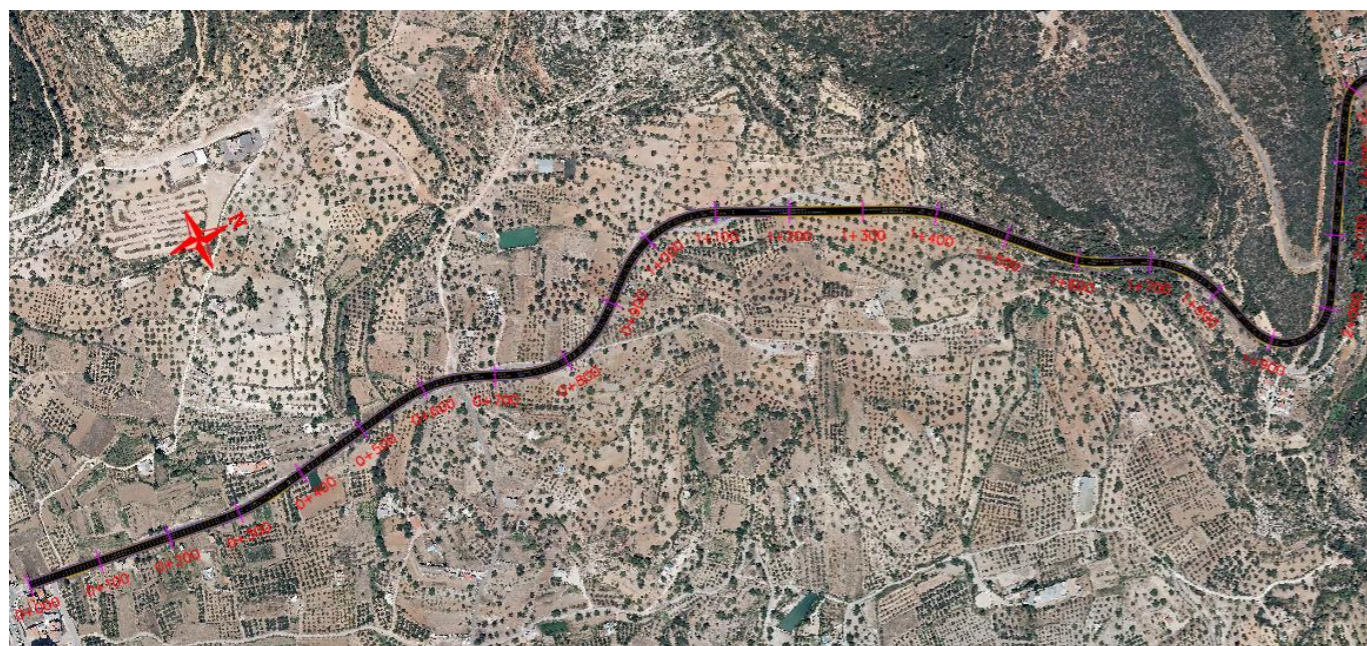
Vista en planta del tramo 1 modificado. (Fuente: Elaboración propia).
